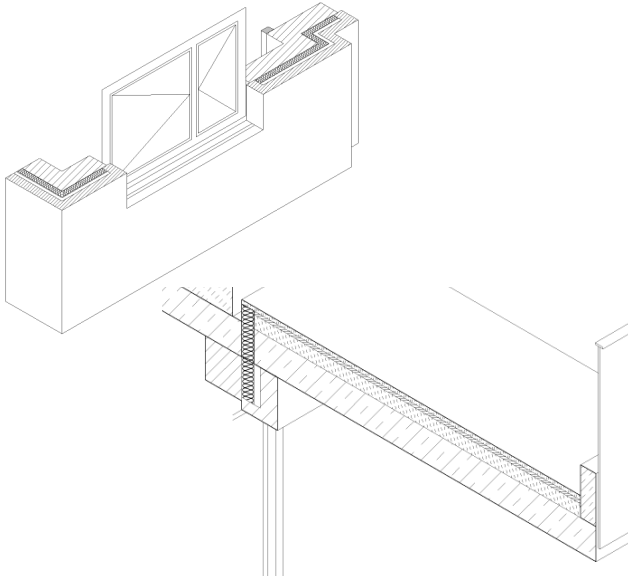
Mehrschalige Wand- Deckenkonstruktion
